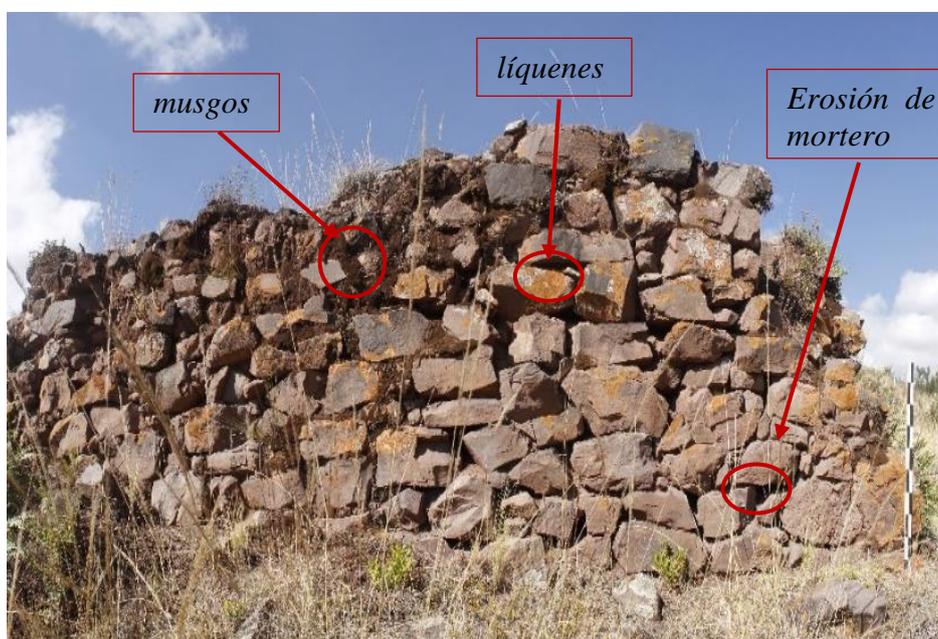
RQO- 1, estructura donde se evidencia el mal estado de conservación de las estructuras de este sitio. Foto: TESISTA
